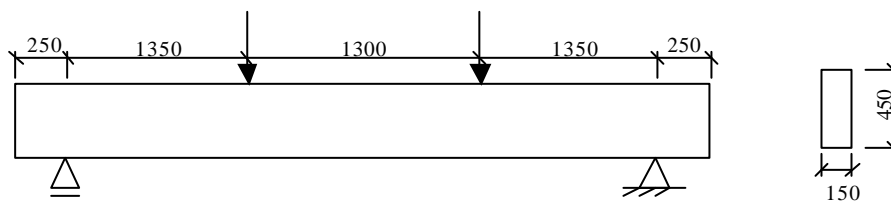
Geometria e carregamento das vigas de Pinto e Cerqueira (2000).
